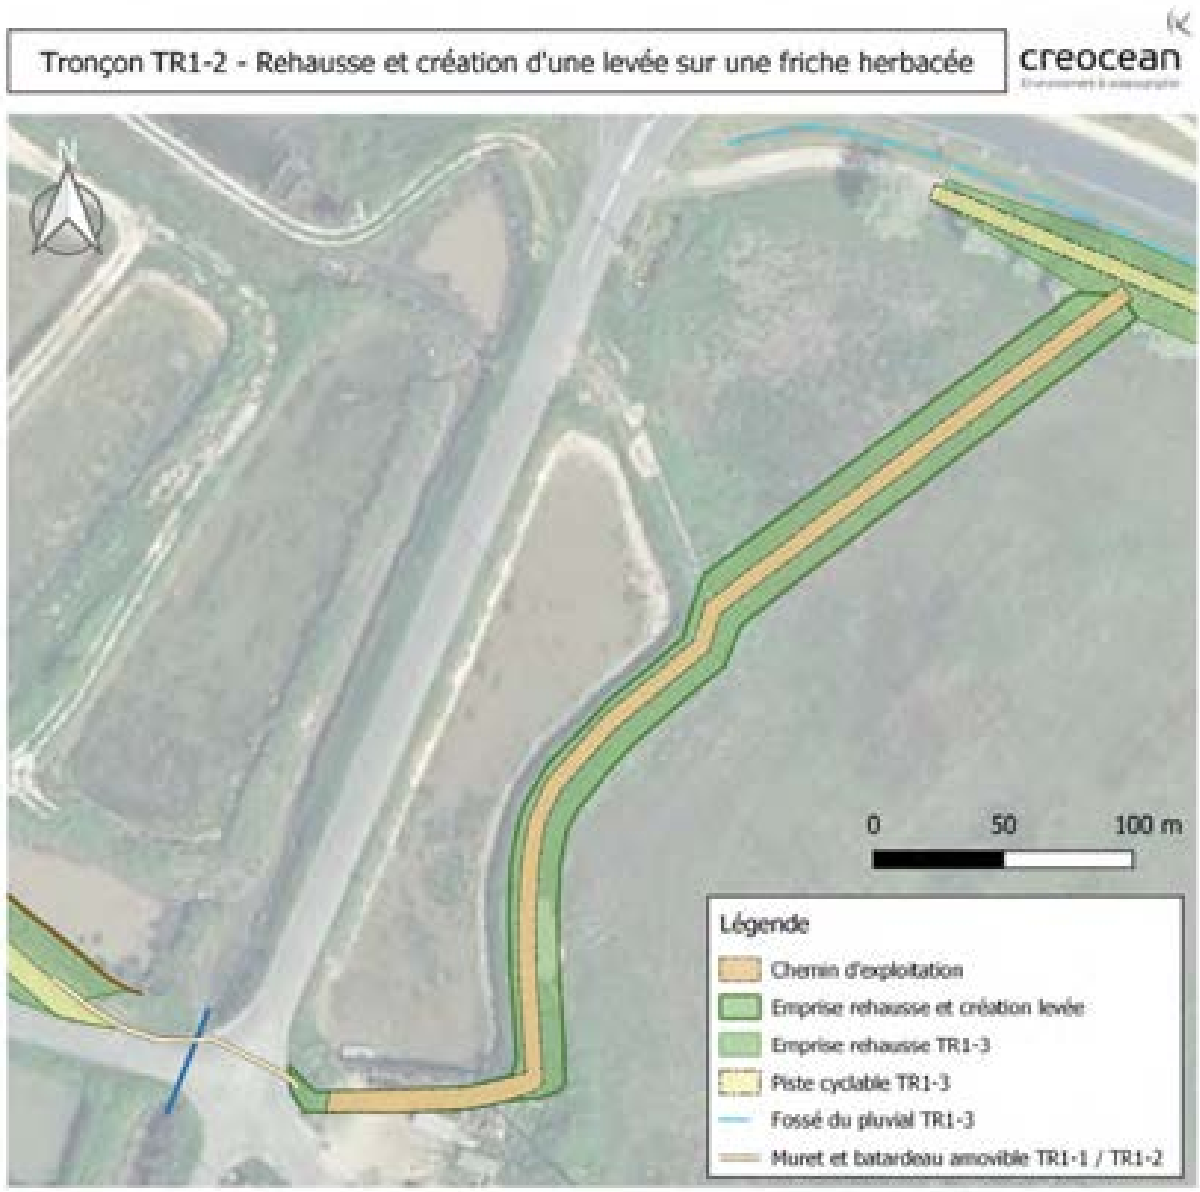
Vue en plan de l'implantation du Tronçon TR1-2– rehausse et création d'une levée sur une friche herbacée.
